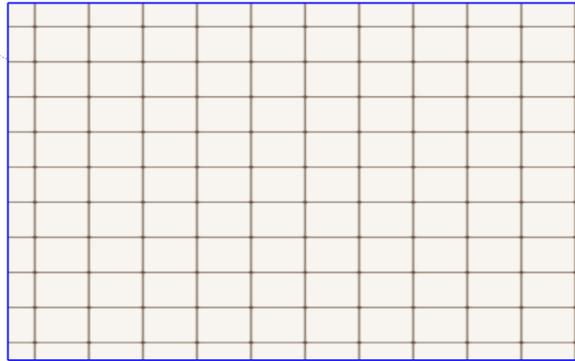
Rencana Plafon Kantor BLK lantai 1
